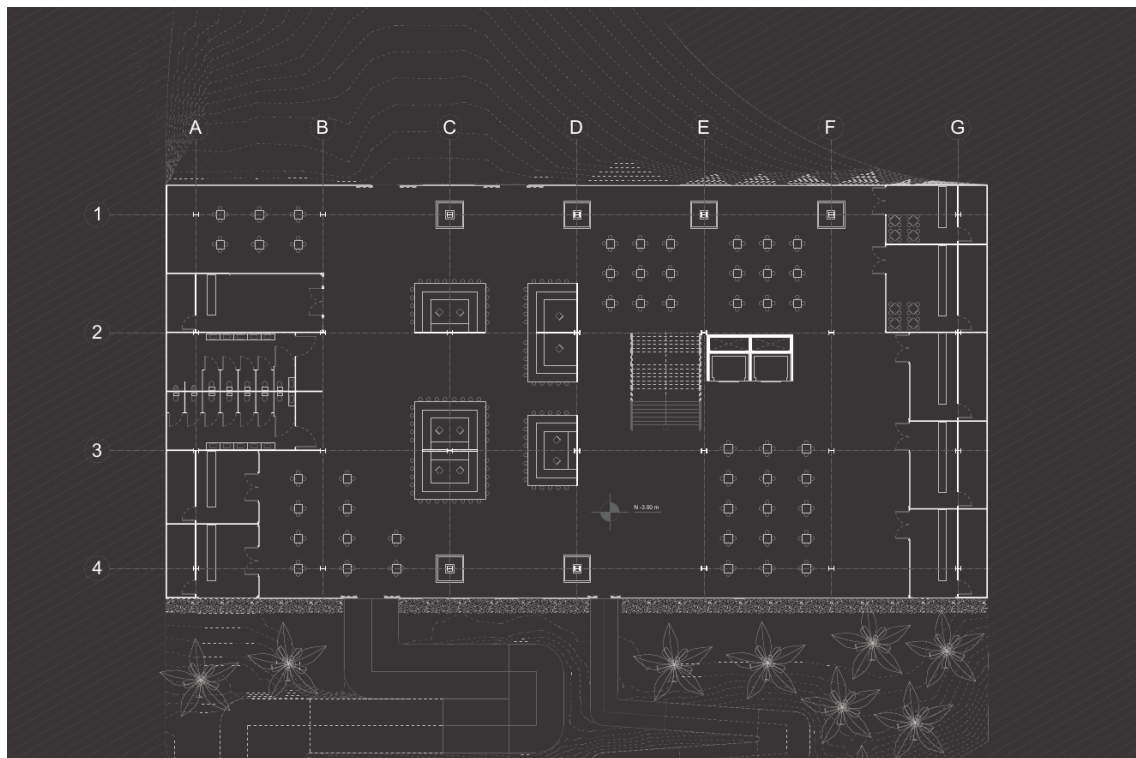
Planta nivel -3.00, Fuente: Elaboración propia
